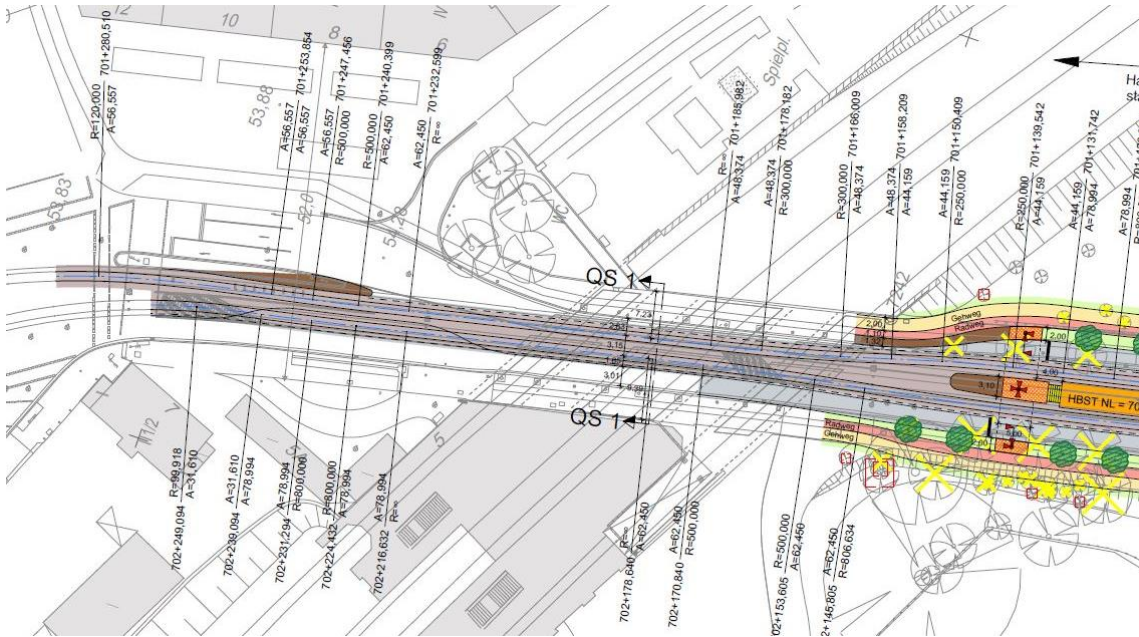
Ausschnitt aus dem Lageplan Variante 7
